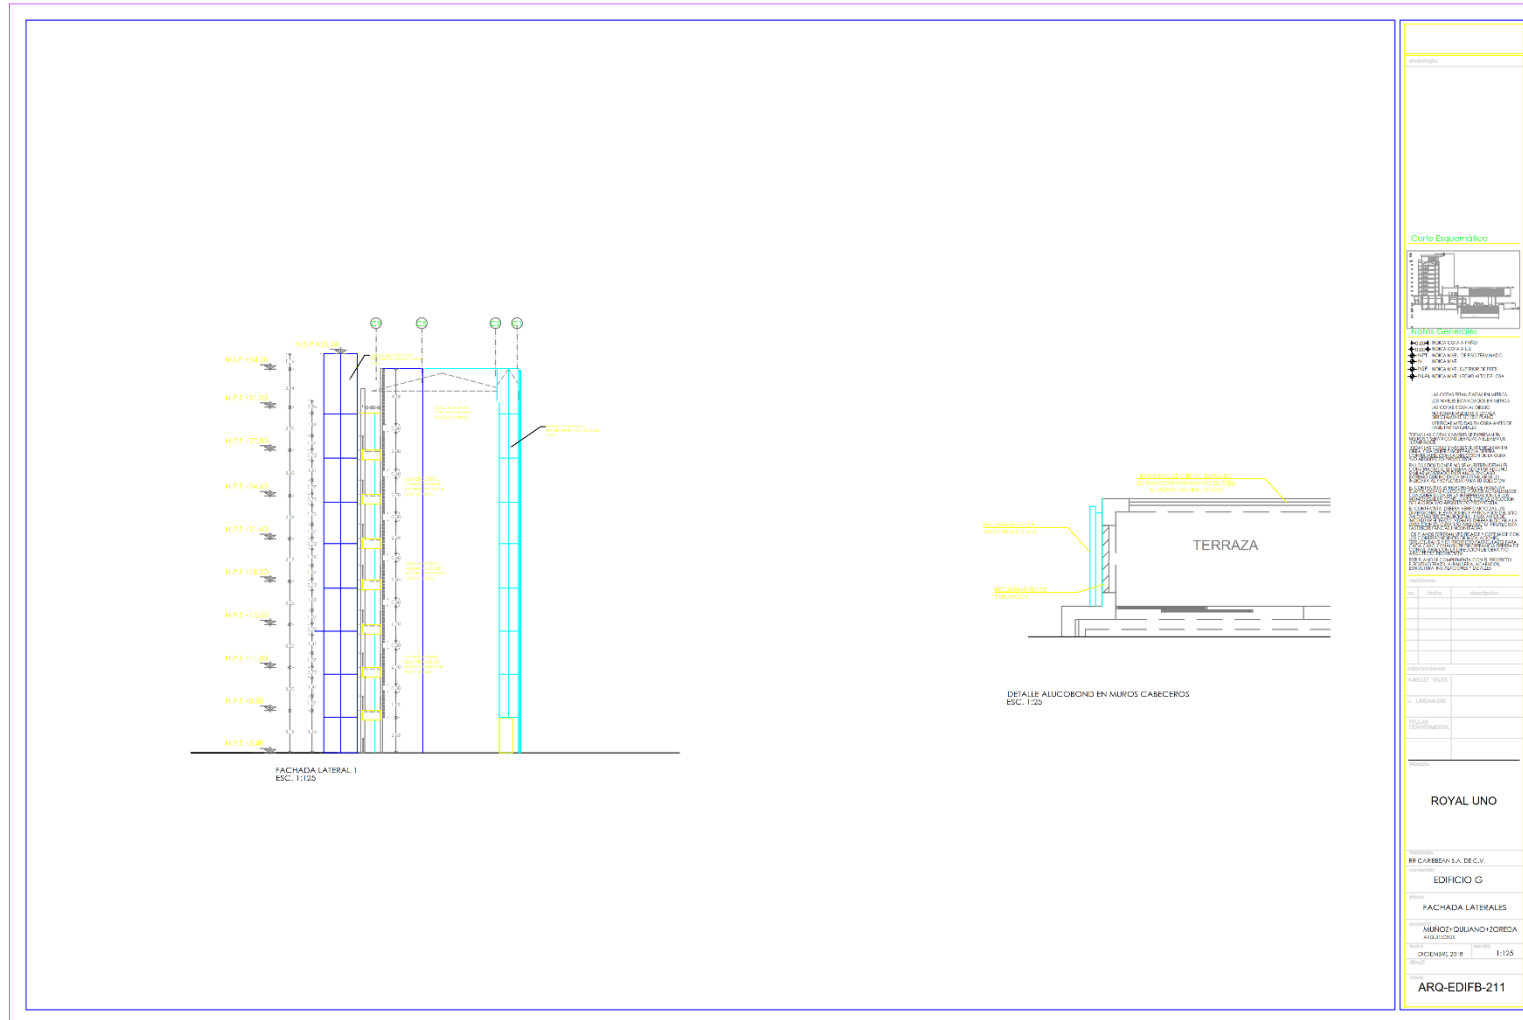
Edificio G, Fachada lateral. Anexo C-7.
